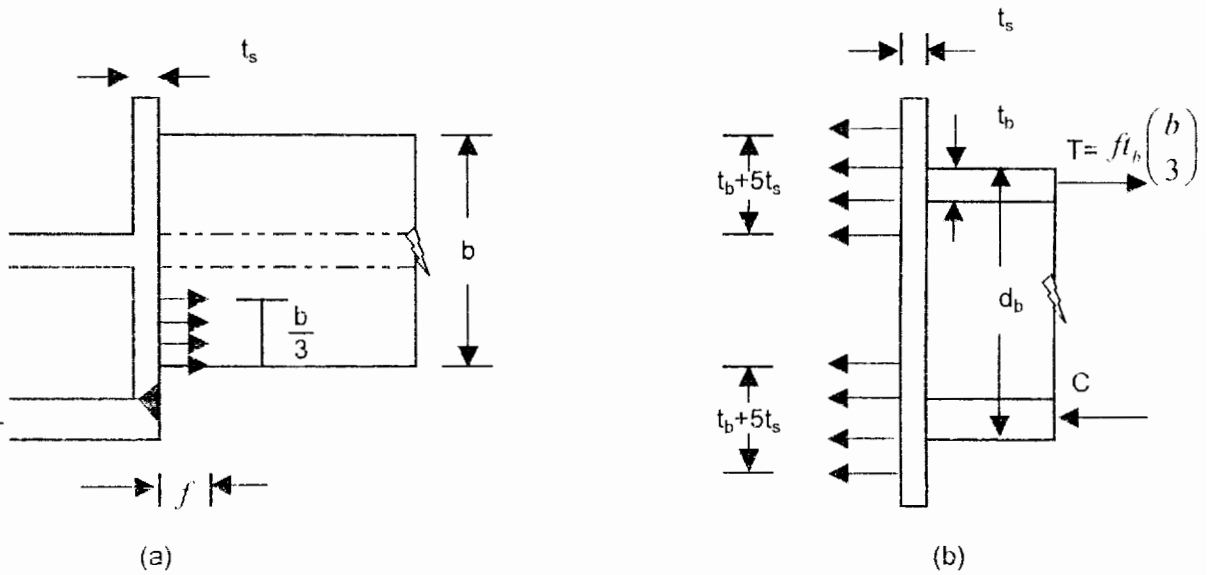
fuerzas llevado por la soldadura a lo largo de los patines de la T rigidizador.
